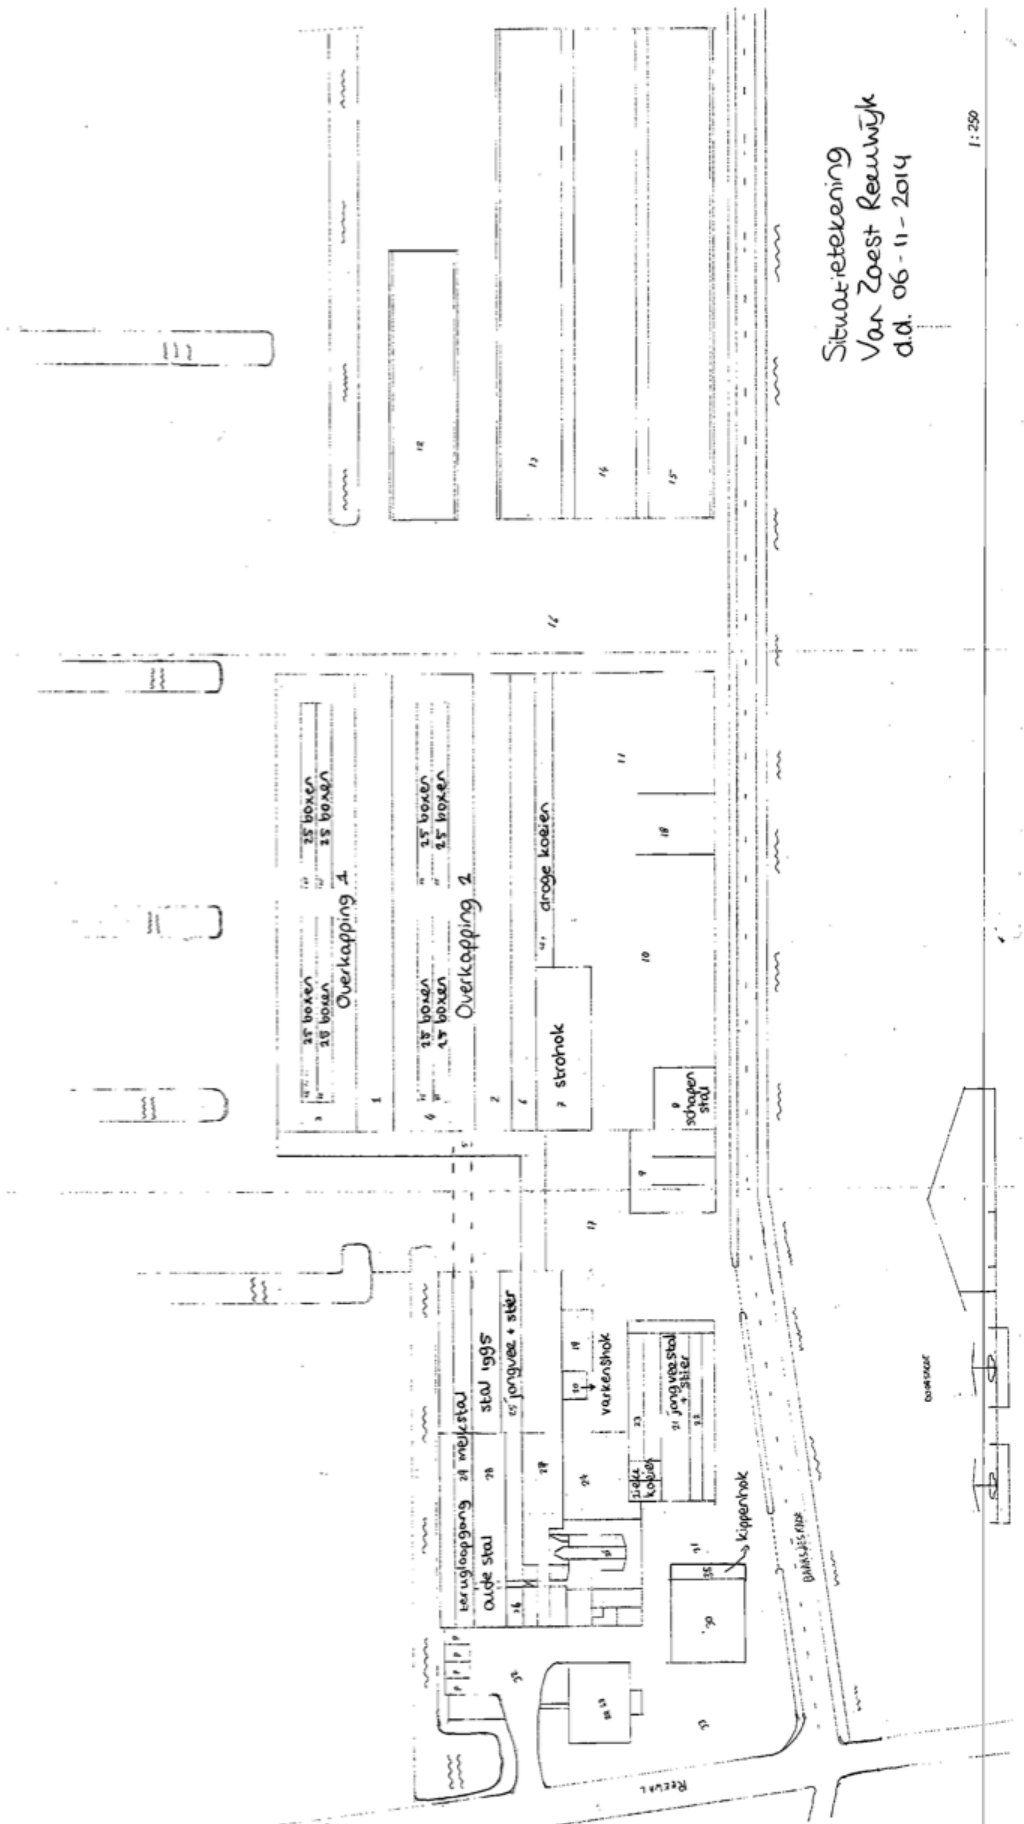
De beoogde ontwikkeling bestaat uit een uitbreiding in noordelijke richting. Hiertoe is de demp van enkele sloten en slootdelen voorzien.
